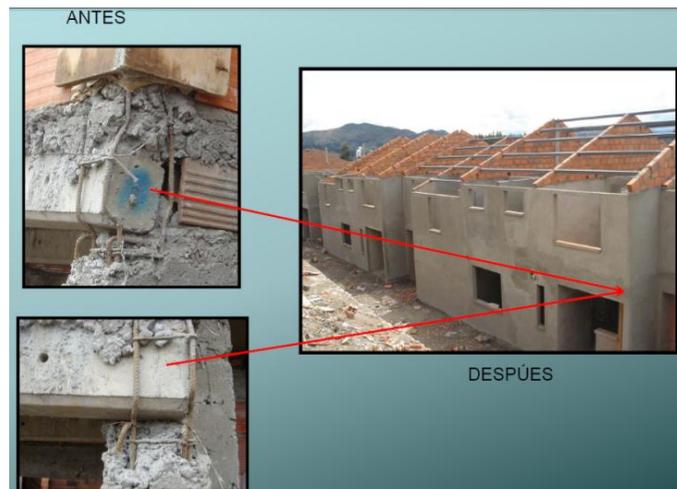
Vivienda que muestra problemas constructivos que comprometen la seguridad estructural, cubierto posteriormente por enlucidos.
